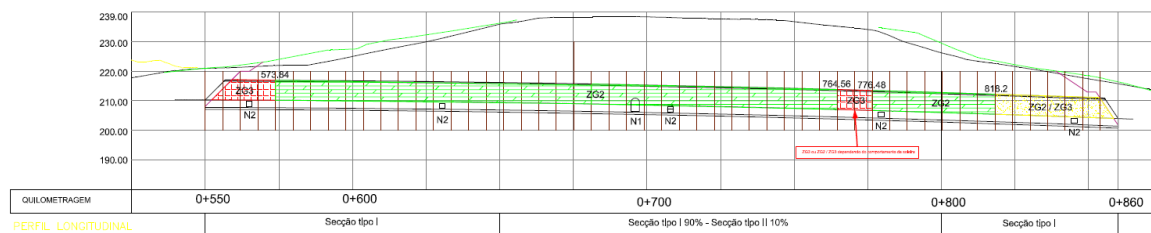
Zonamento geotécnico da fase de construção da galeria Norte
